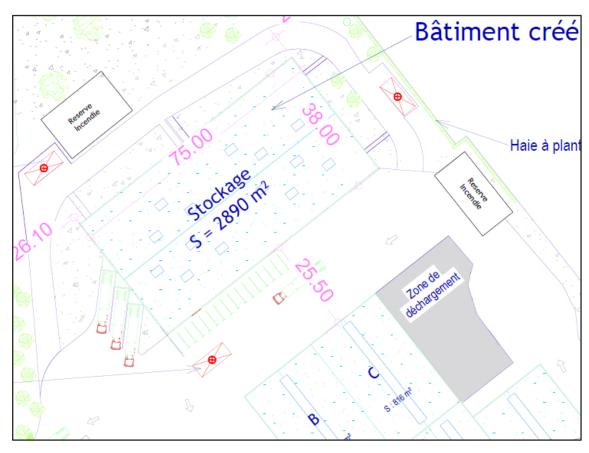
Aménagement futur de bâtiment (source : sicabconstruction)
